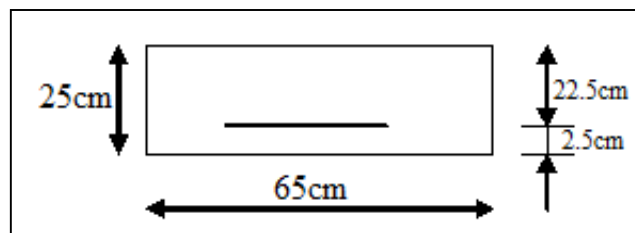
Section théorique pour le ferrailage du plancher (en travée)
